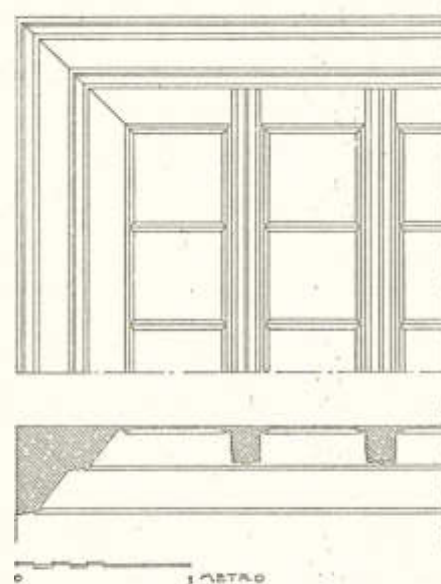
Saluzzo - Casa Cavassa. Soffitto della sala delle Sibille
